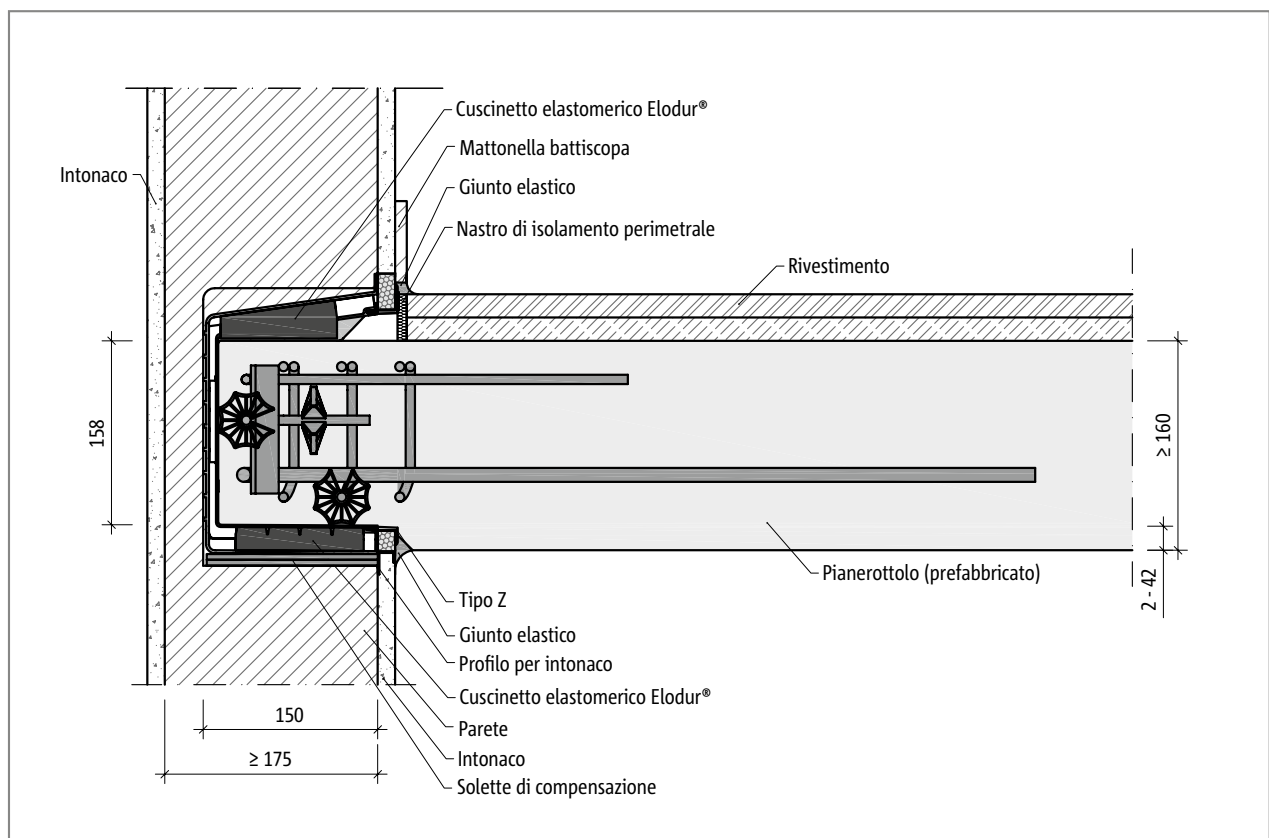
Schöck Tronsole® tipo Z-V+V-T: sezione costruttiva - Pianerottolo prefabbricato
